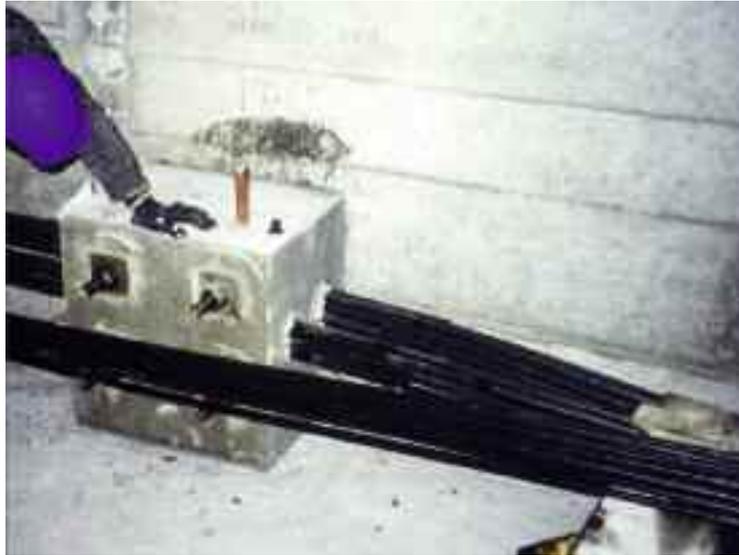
câbles constitués de monotorons gainés-protégés libres (photo LRPC)
